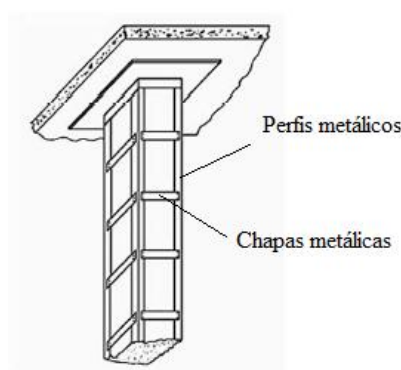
Reforço de pilar com perfis e chapas metálicas (SOUZA & RIPPER, 1998)
